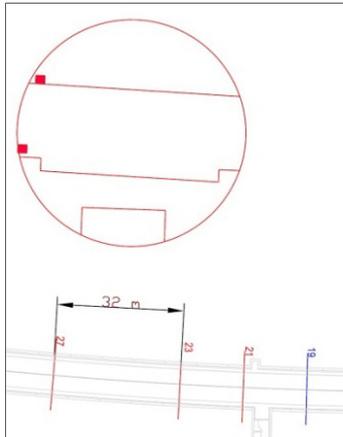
Platzierung der Erschütterungssensoren im Tunnelprofil (rot) [4]
